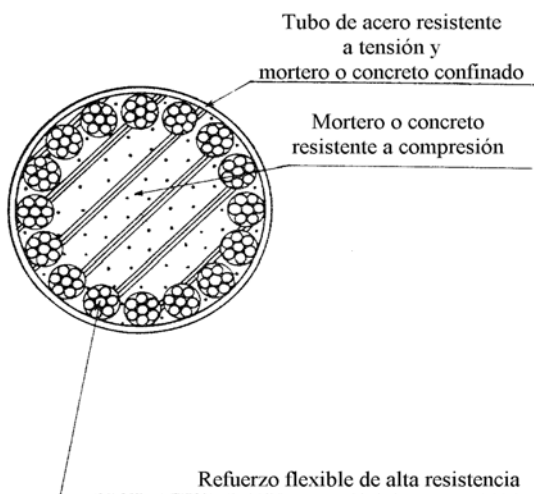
Sección transversal de un pilote flexible de concreto armado con tubo de acero (Fukuoka, 1977).
